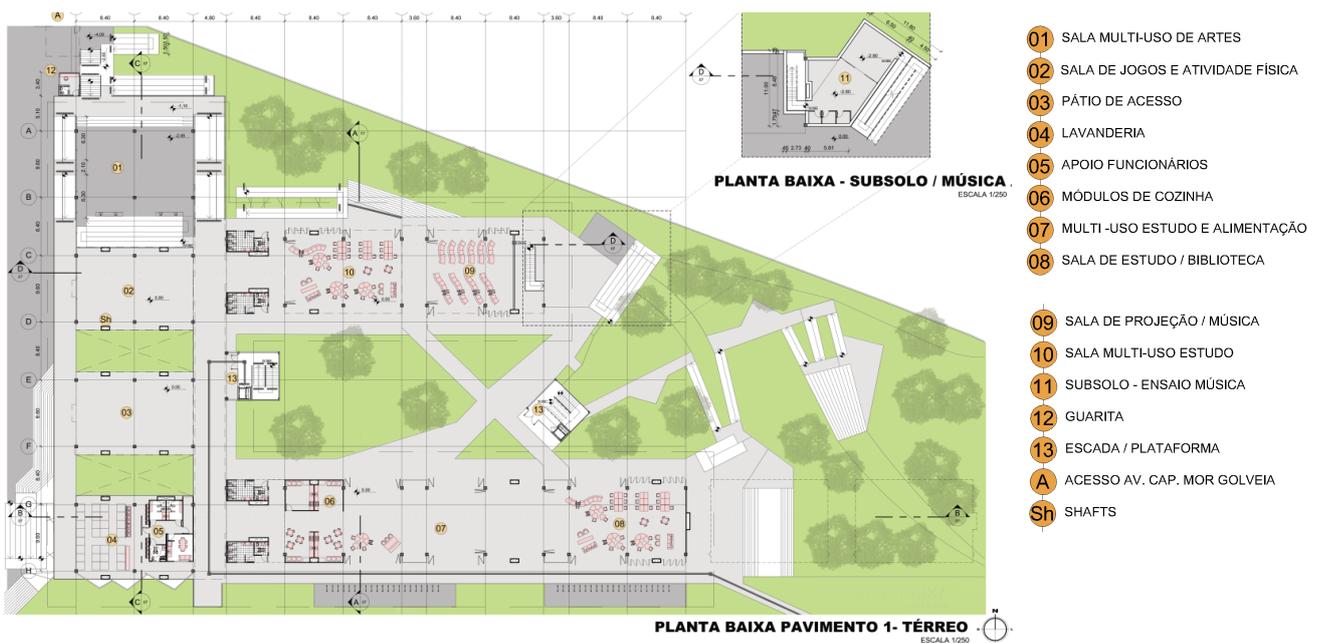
Planta do Pavimento Térreo e Subsolo. Fonte: Barros (2016).
